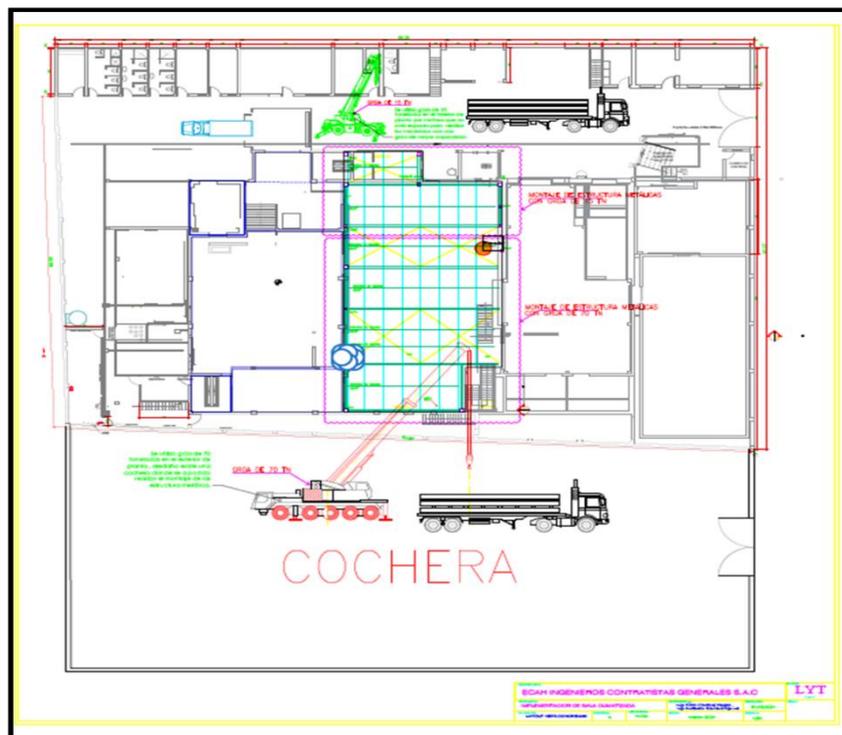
Layout de Montaje de estructura metálica 1er nivel
